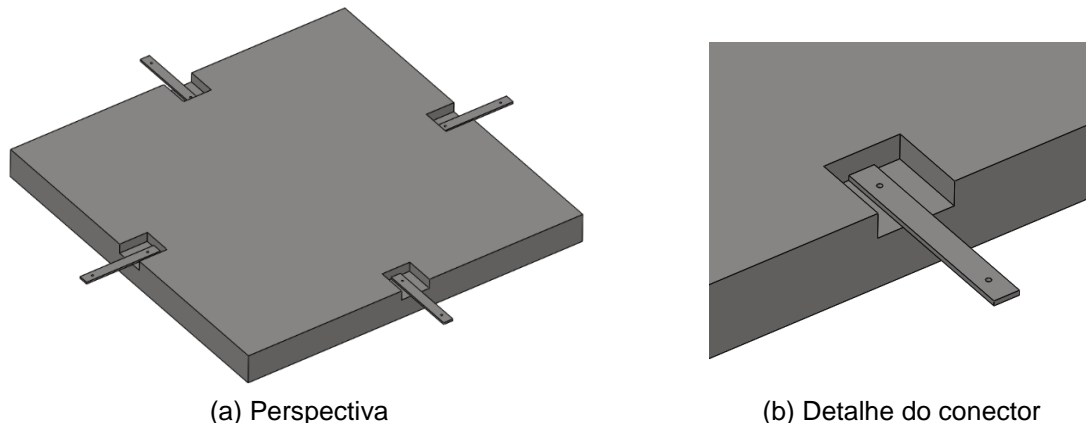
Placa alveolar tipo radier pré-fabricada modular de concreto armado
